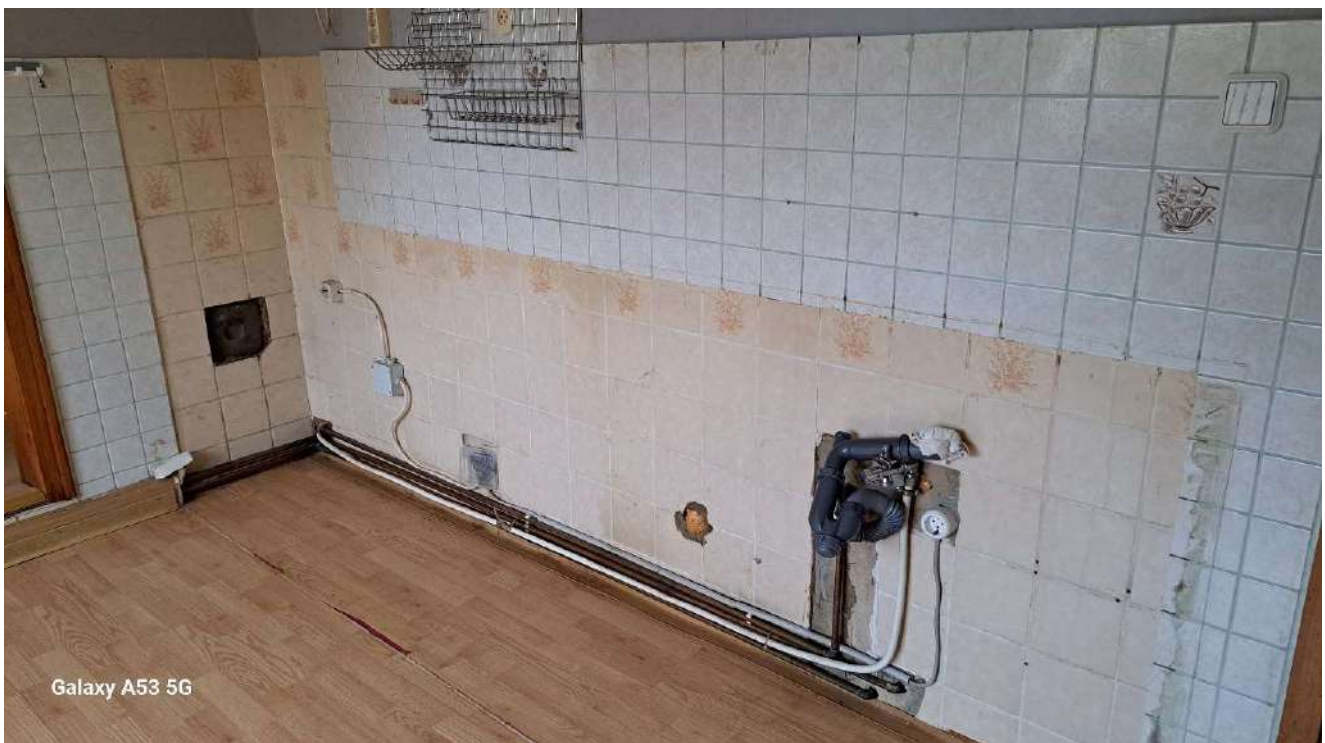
Gebäudeinnansicht EFH, exemplarisch
